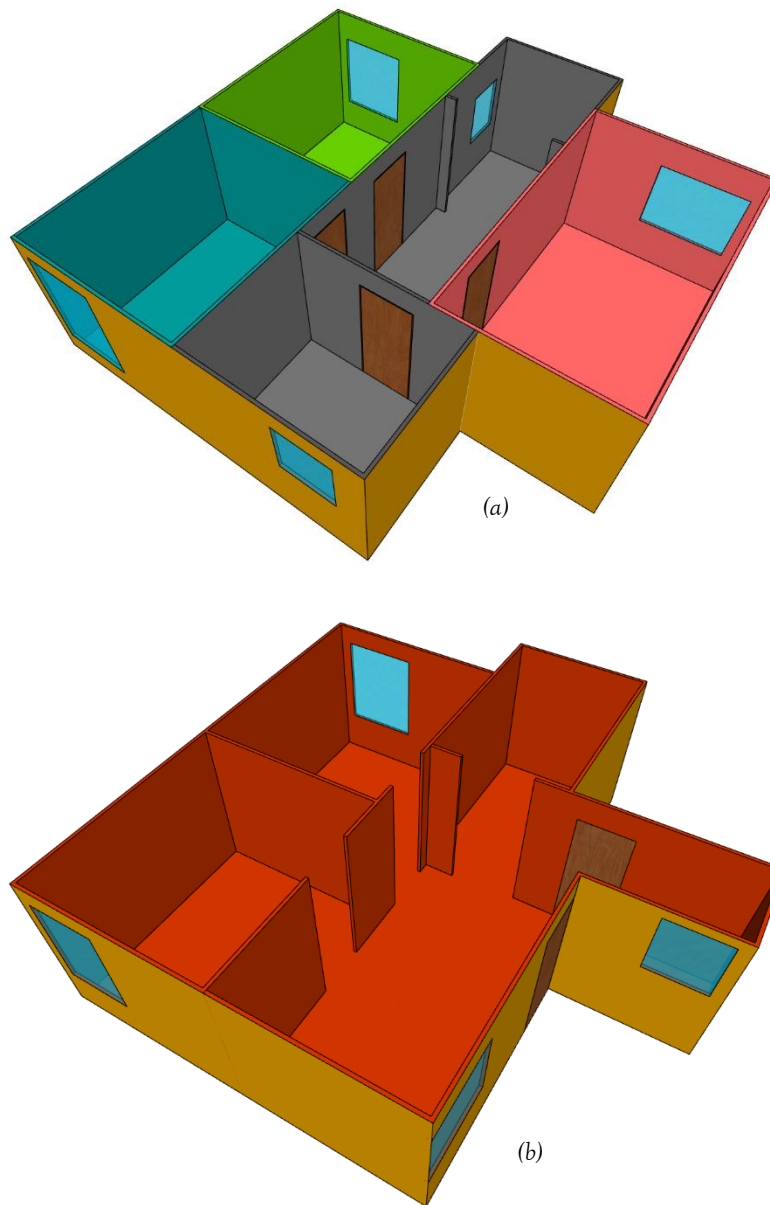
Zonas térmicas (a) planta alta (b) planta baja
